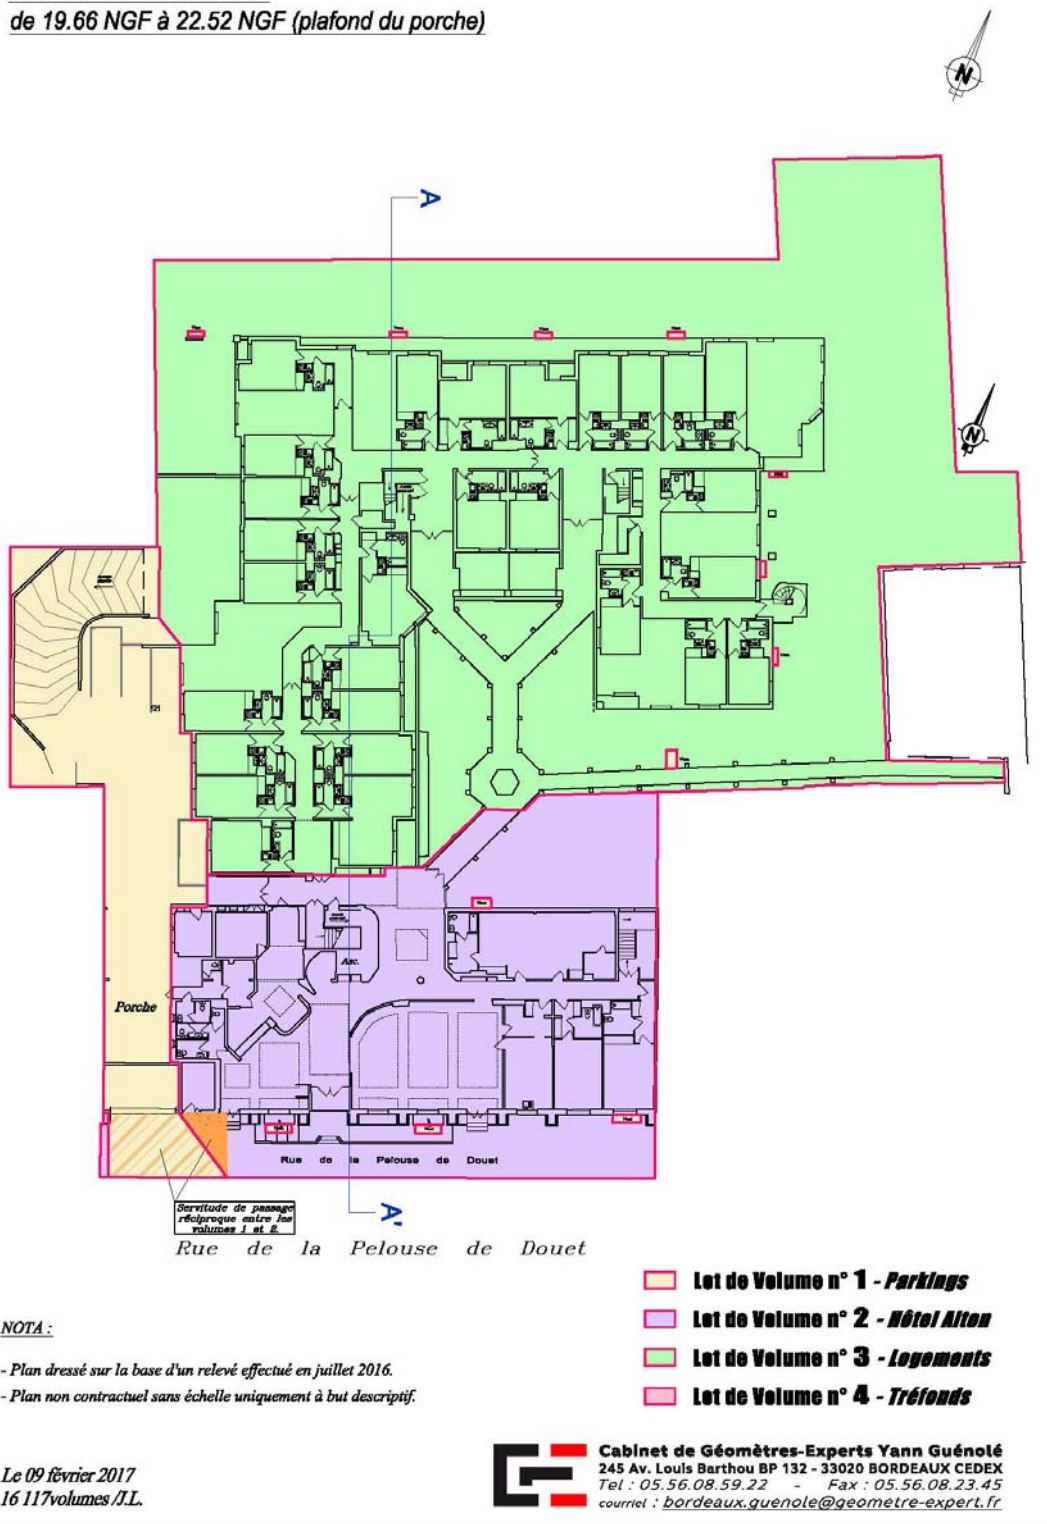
Plan du rez-de-chaussée de la résidence hôtelière ALTON
